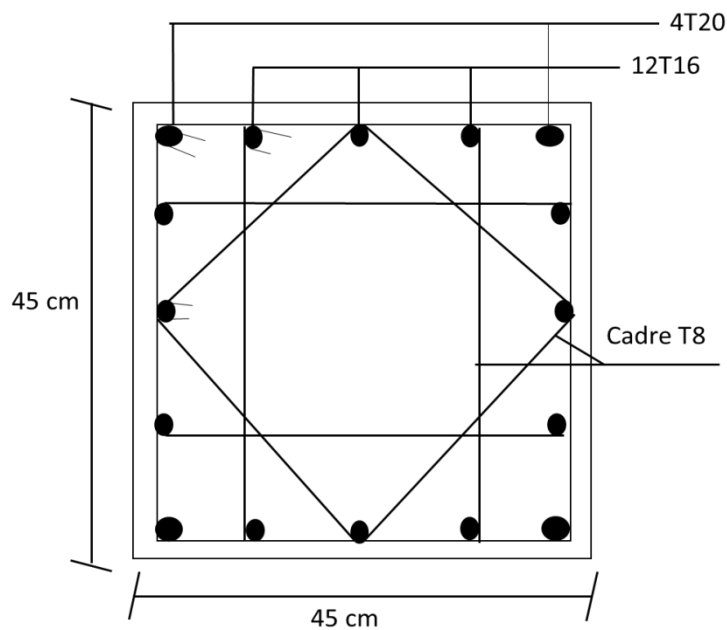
schéma du ferrailage du Poteau 10^{ème}, 9^{ème} et 8^{ème} étage.
